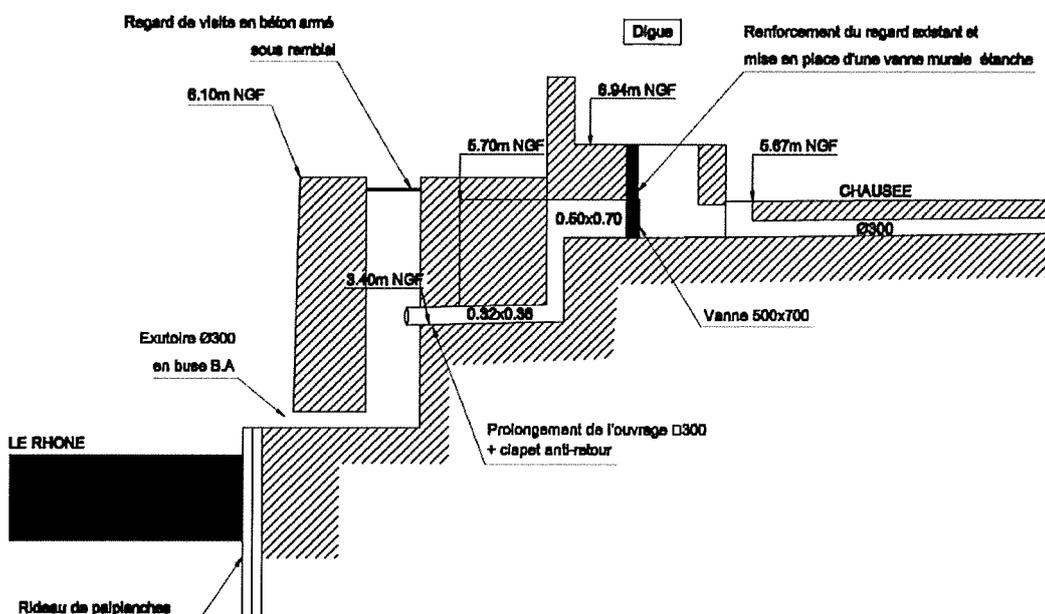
travaux réalisés en 2009 sur OH9 (au droit du mur reconstruit) (source EDD ISL 2017)
